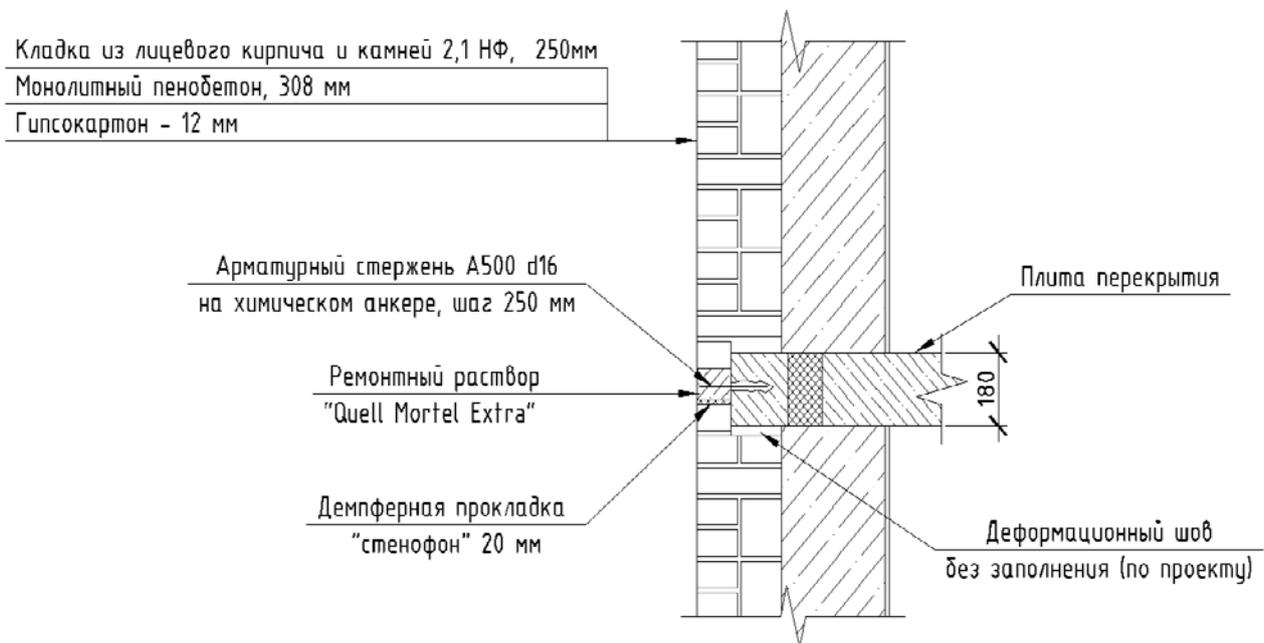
Узел опирания наружной версты кладки, совмещенный с деформационным швом
